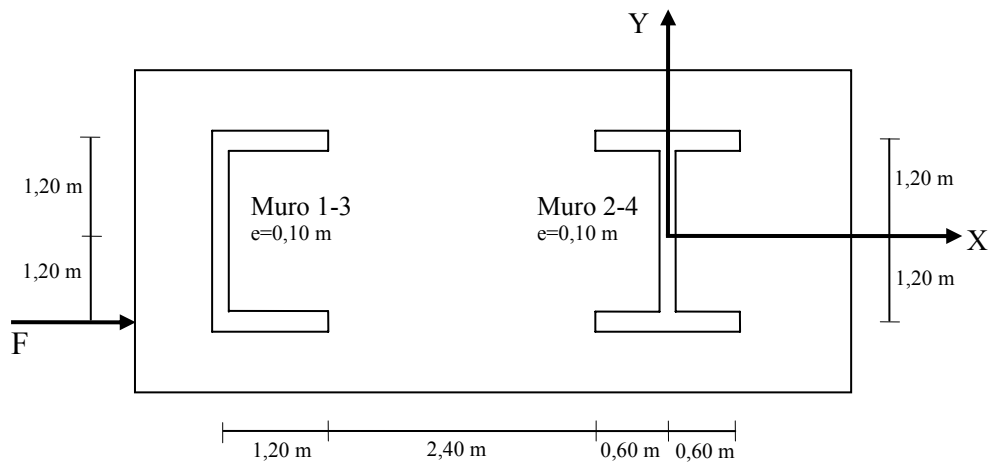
Geometría en Planta de los Muros Estructurales.
